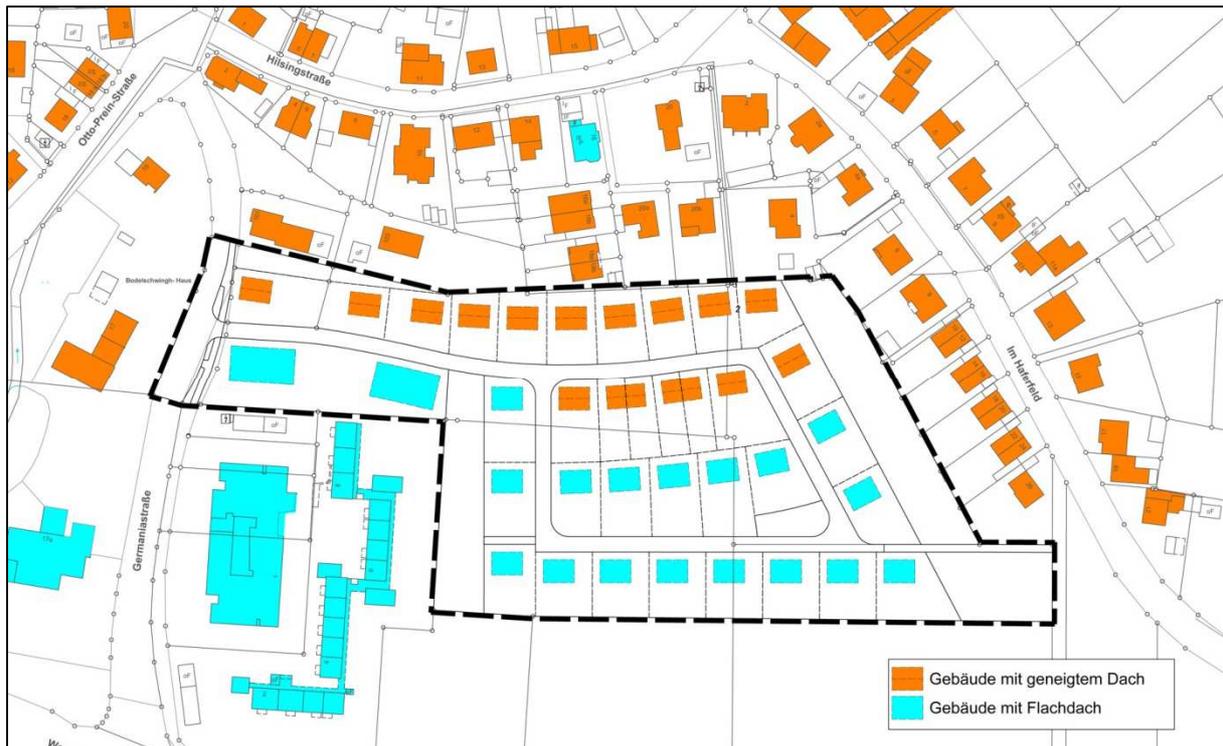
Zonierung des Plangebietes hinsichtlich der Dachformen
